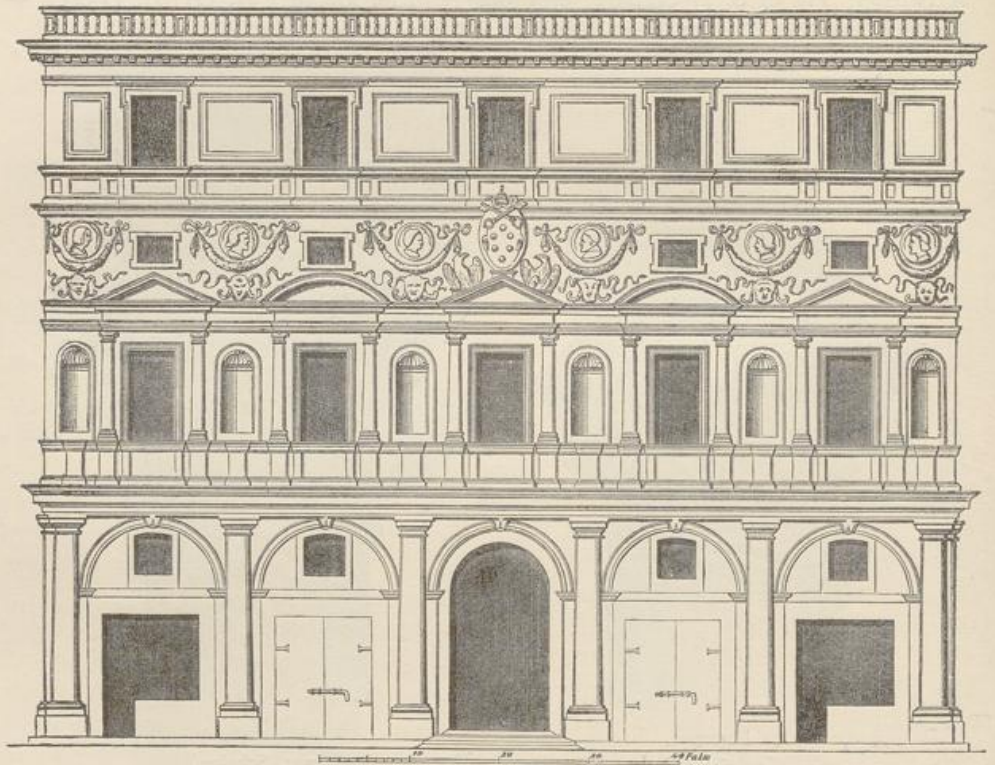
Façade des ehemaligen Pal. dall' Aquila.
